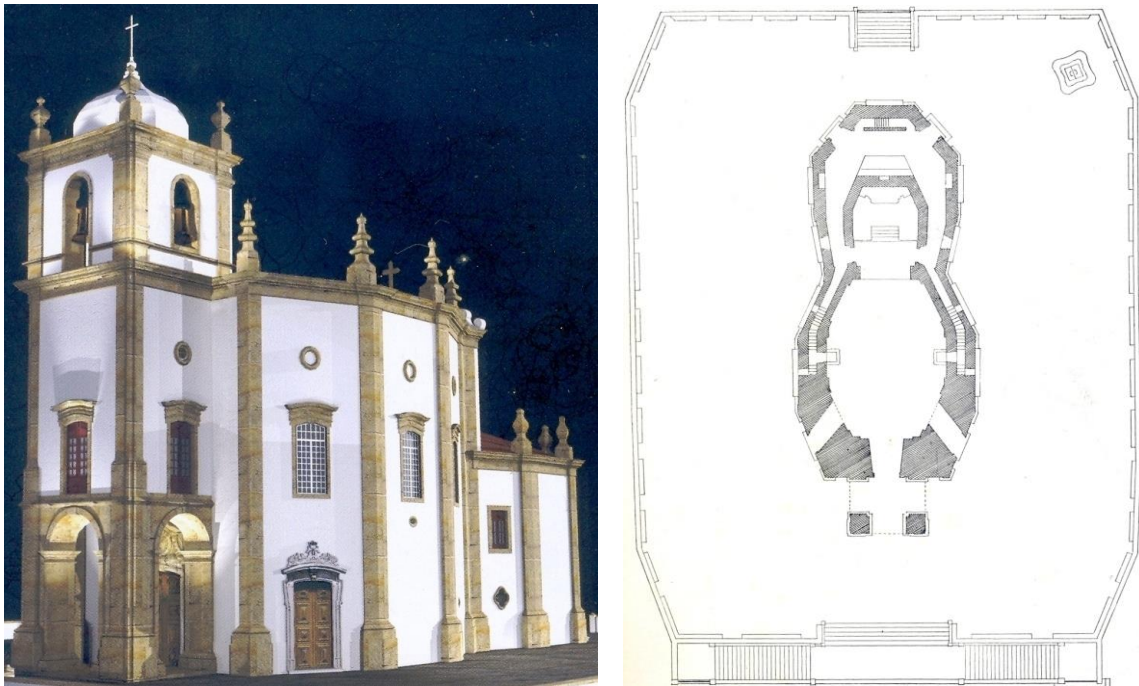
Fachada da Igreja de Nossa Senhora da Glória após a última restauração e Planta baixa
